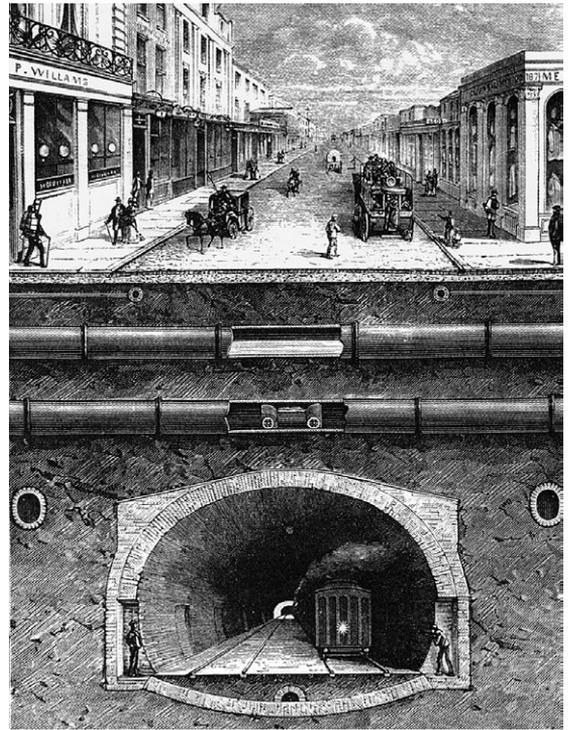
Querschnitt durch eine Londoner Straße, 1875
